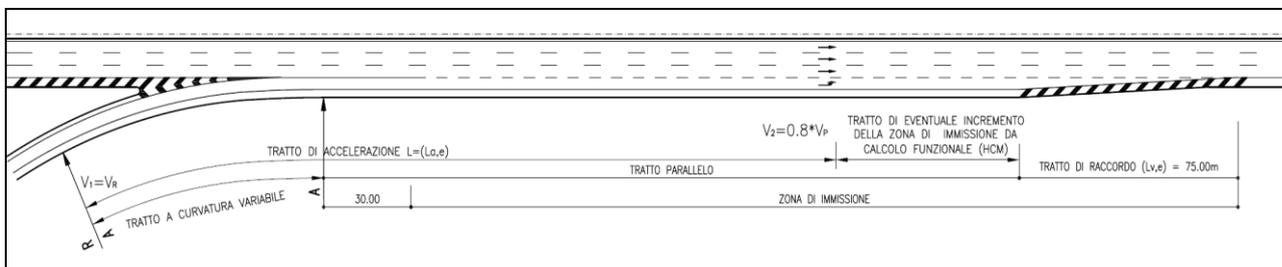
SCHEMA PLANIMETRICO DELLA CORSIA DI IMMISSIONE
